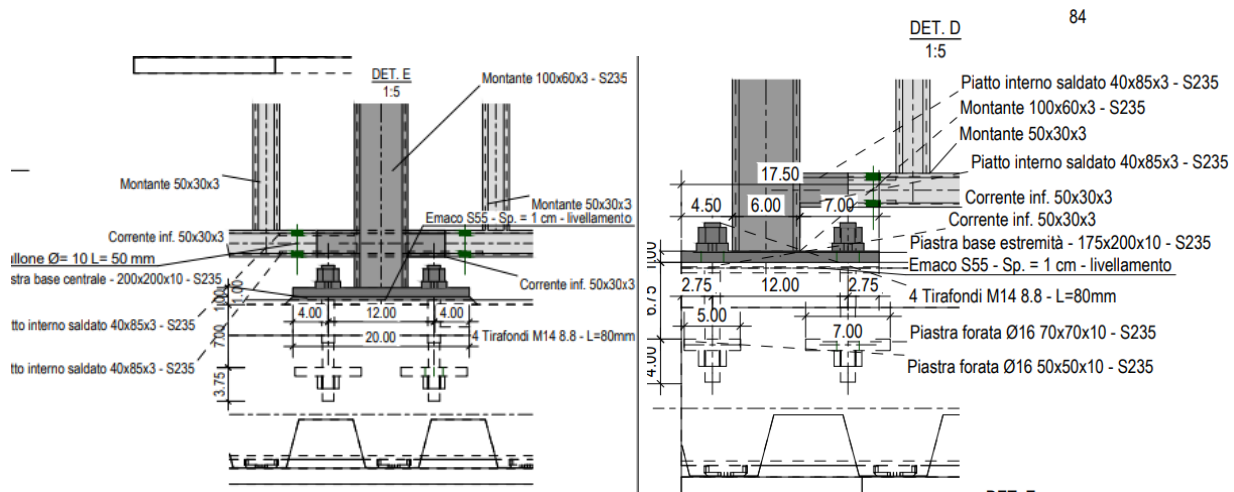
Dettaglio installazione parapetto con tirafondi e piastra di base – a sx caso base per tutte le opere – a dx caso di estremità per opera "2B"
